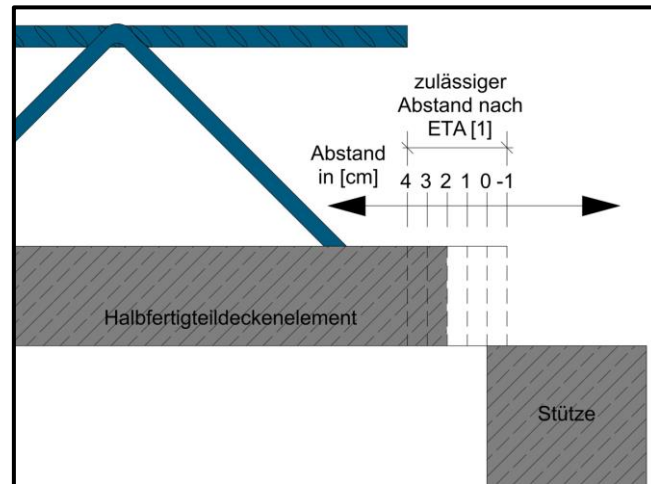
Einbautoleranzen für Halbfertigteildecken mit L-Blechen
